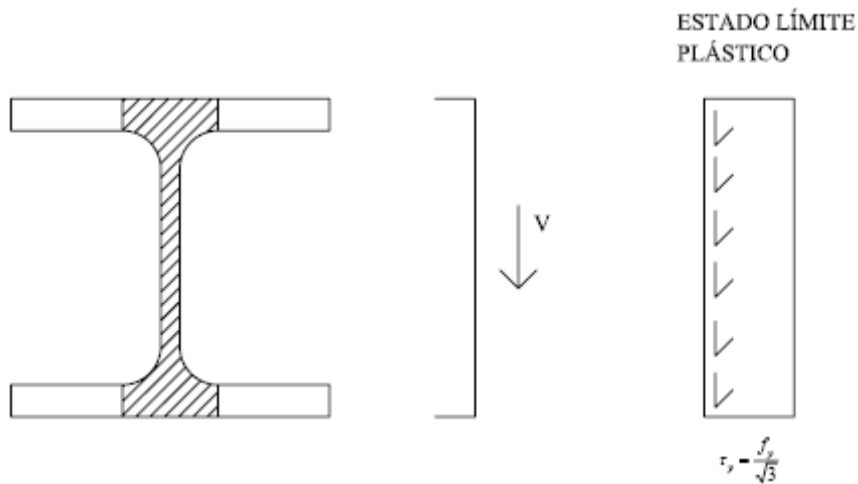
a Área a cortante de un perfil laminado en doble T con carga paralela al alma.
